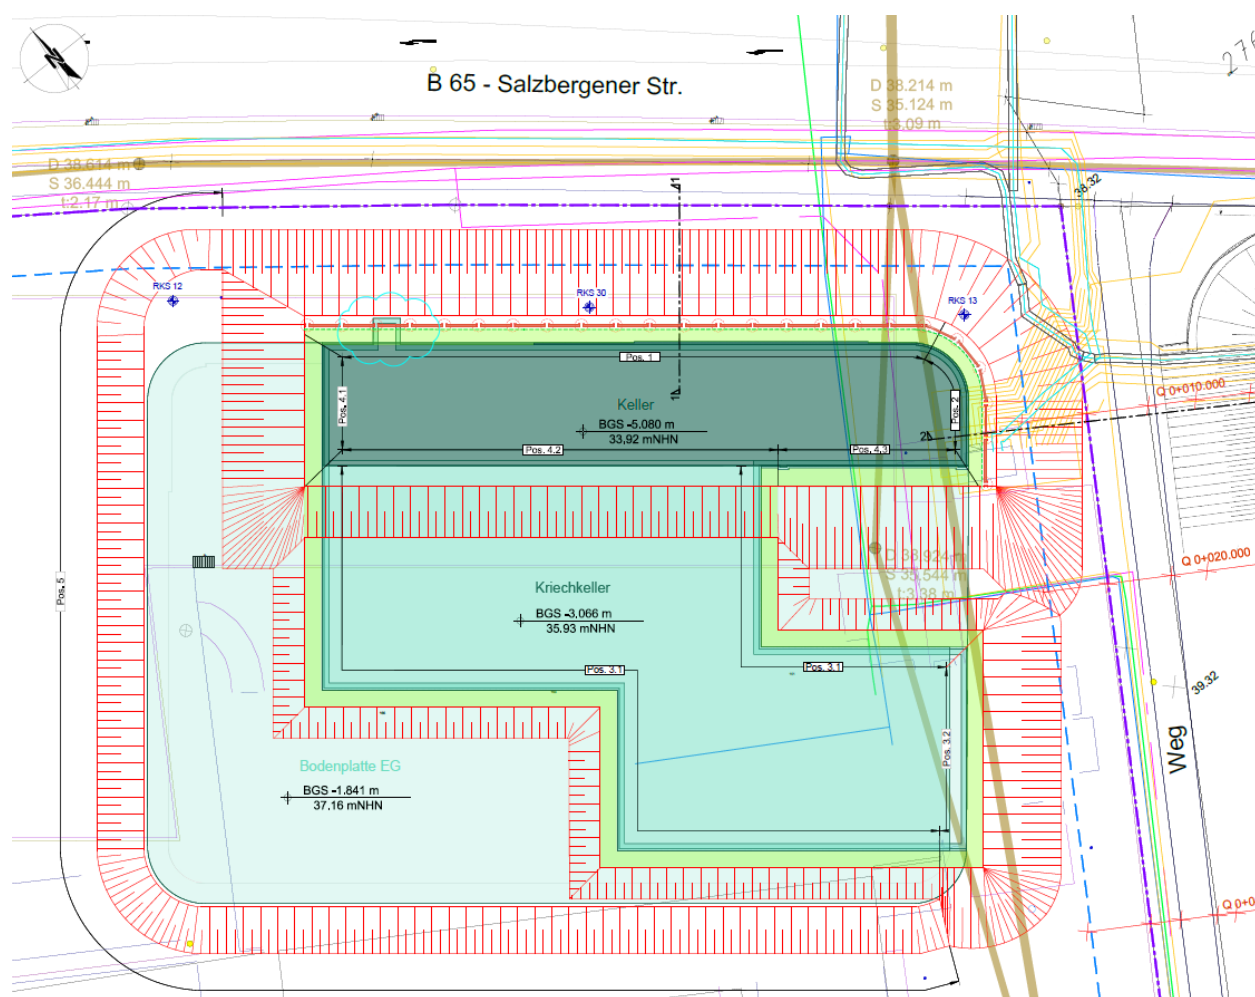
Lageplan der geplanten Baugrube und des Verbau (vgl. Anlage 1.3)
